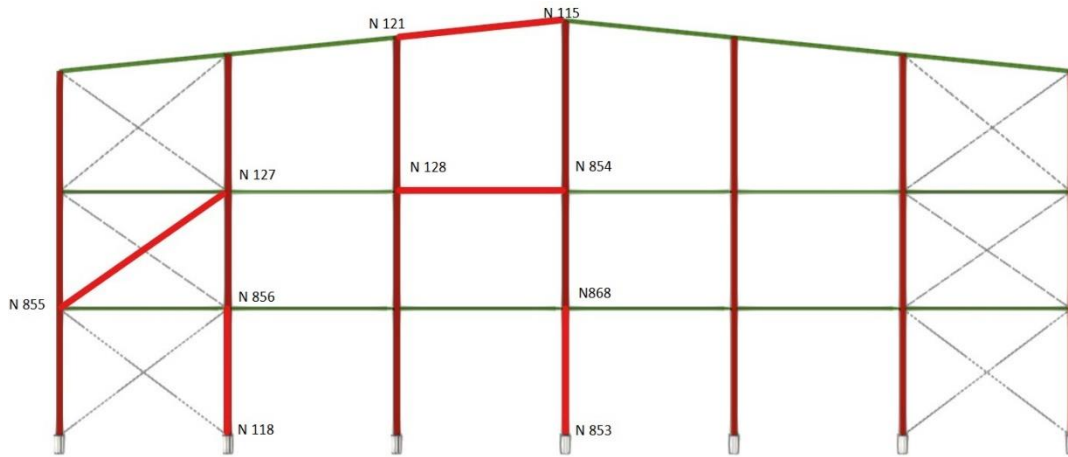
Elementos más significativos del pórtico de fachada (alineación A)
